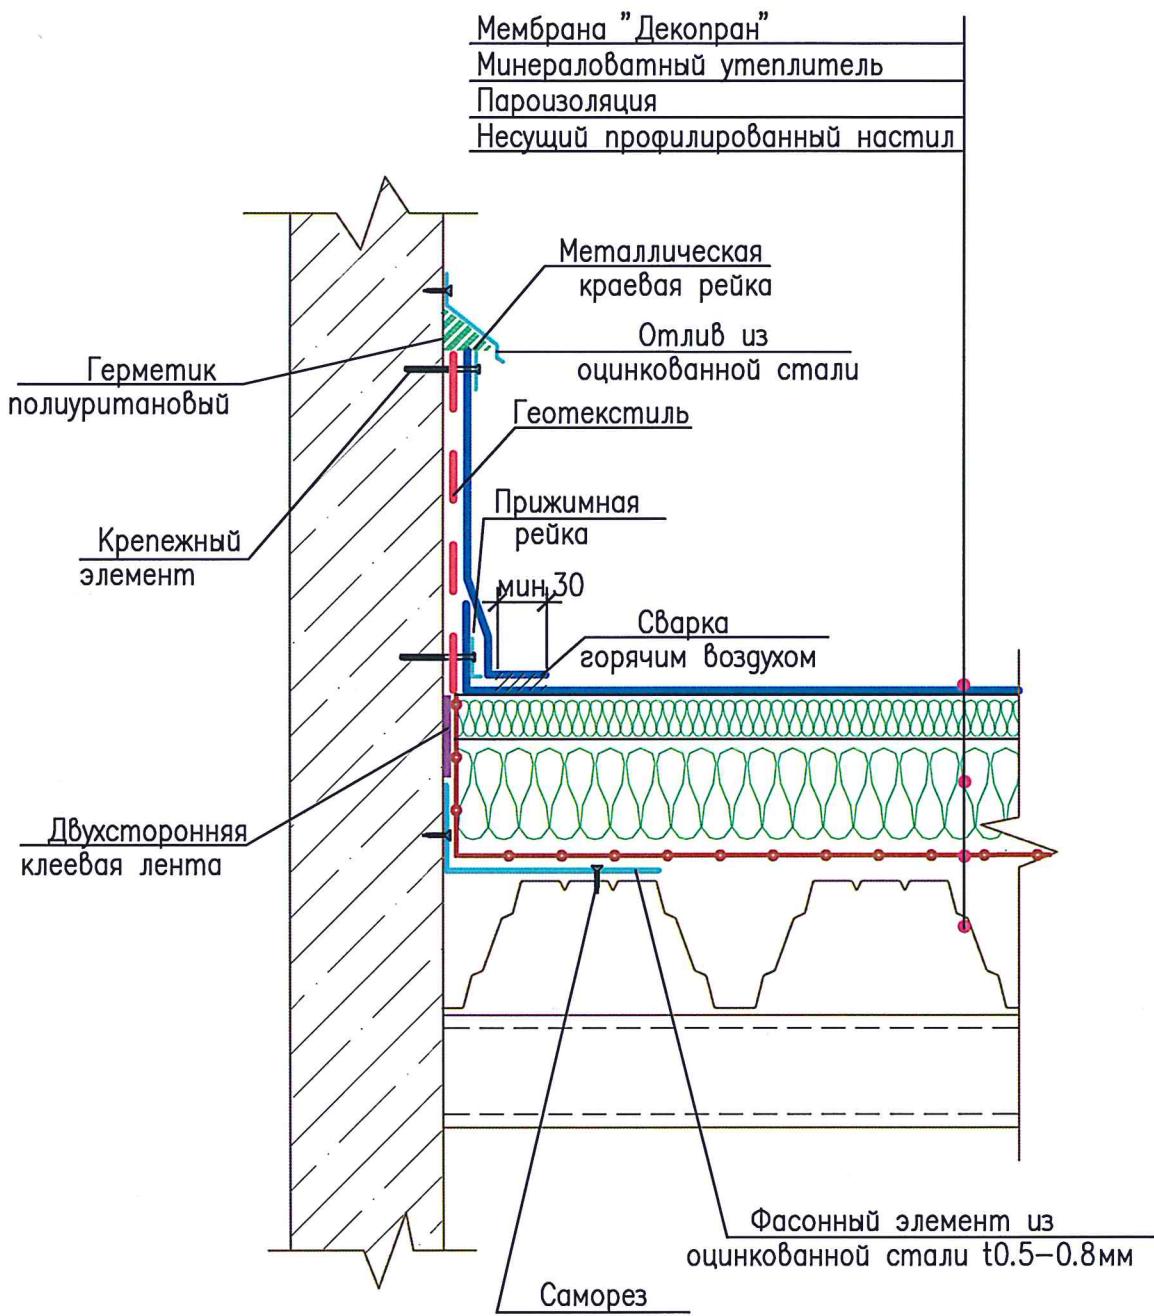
Конструктивные решения узлов для кровли с несущим профилированным настилом с механическим закреплением. Устройство примыкания к стене
